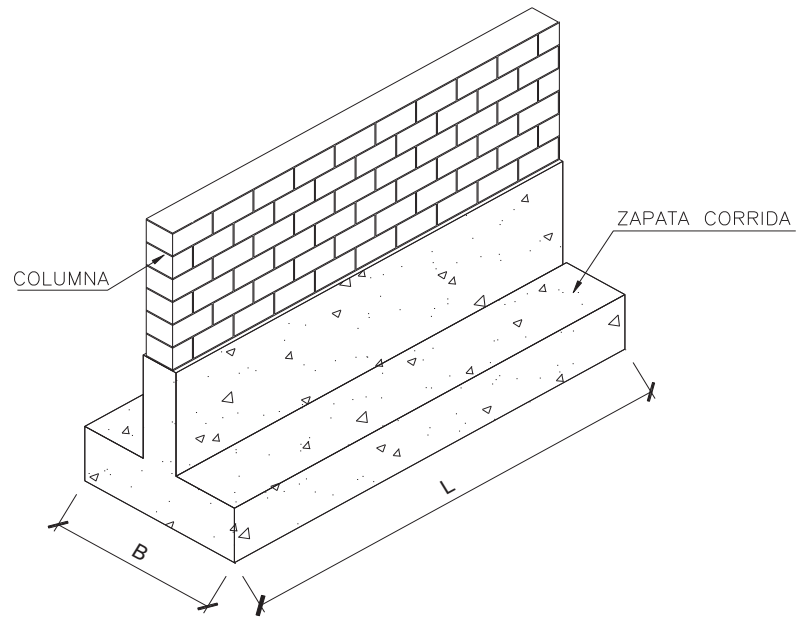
Zapata Corrida Sosteniendo Un Muro
